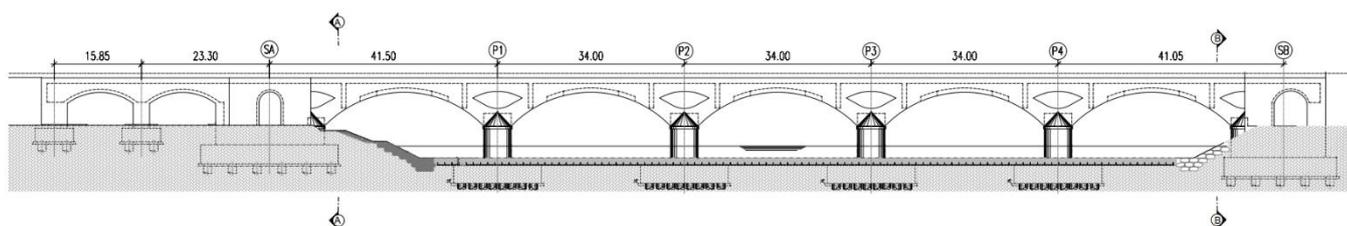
Prospetto nuovo ponte sul Fiume Adige
